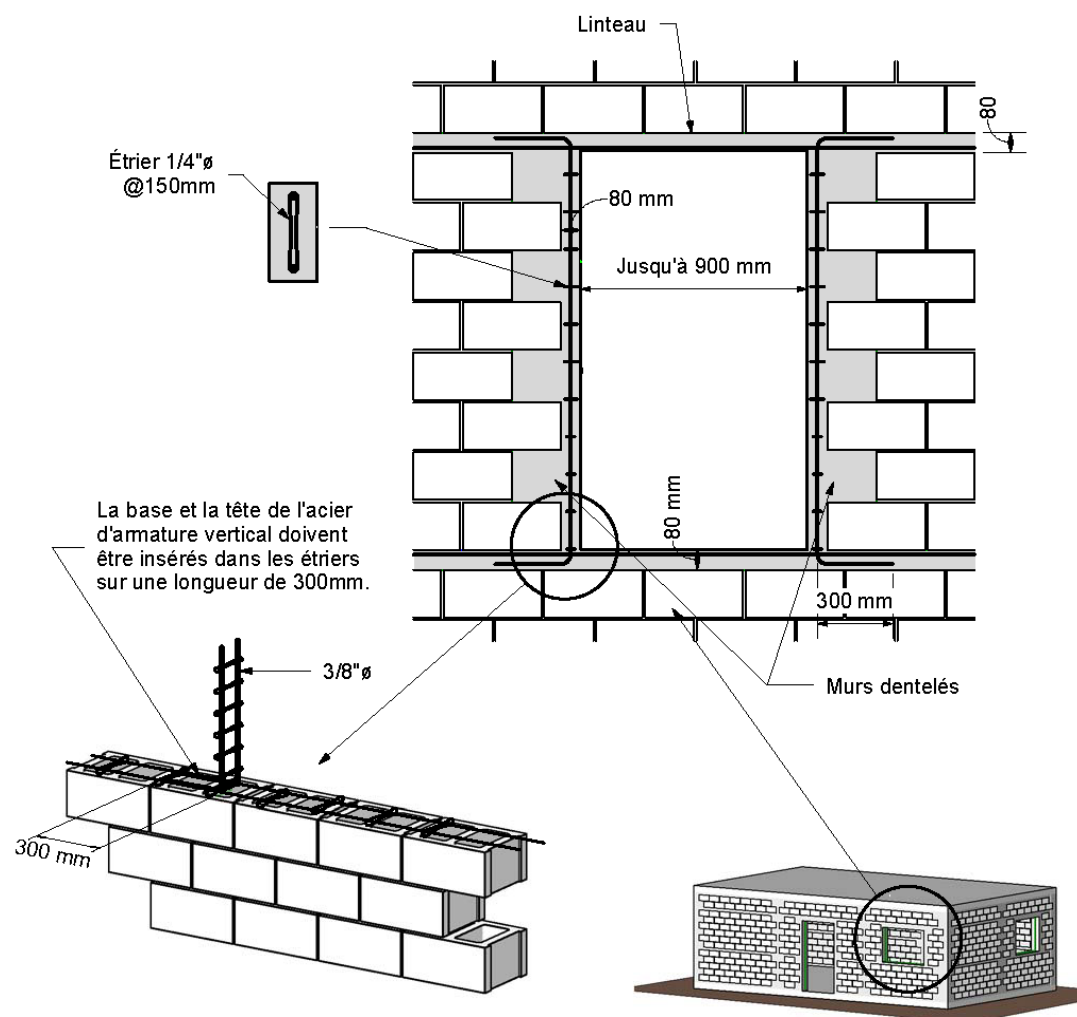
Ferrailage des ouvertures de faible longueur
